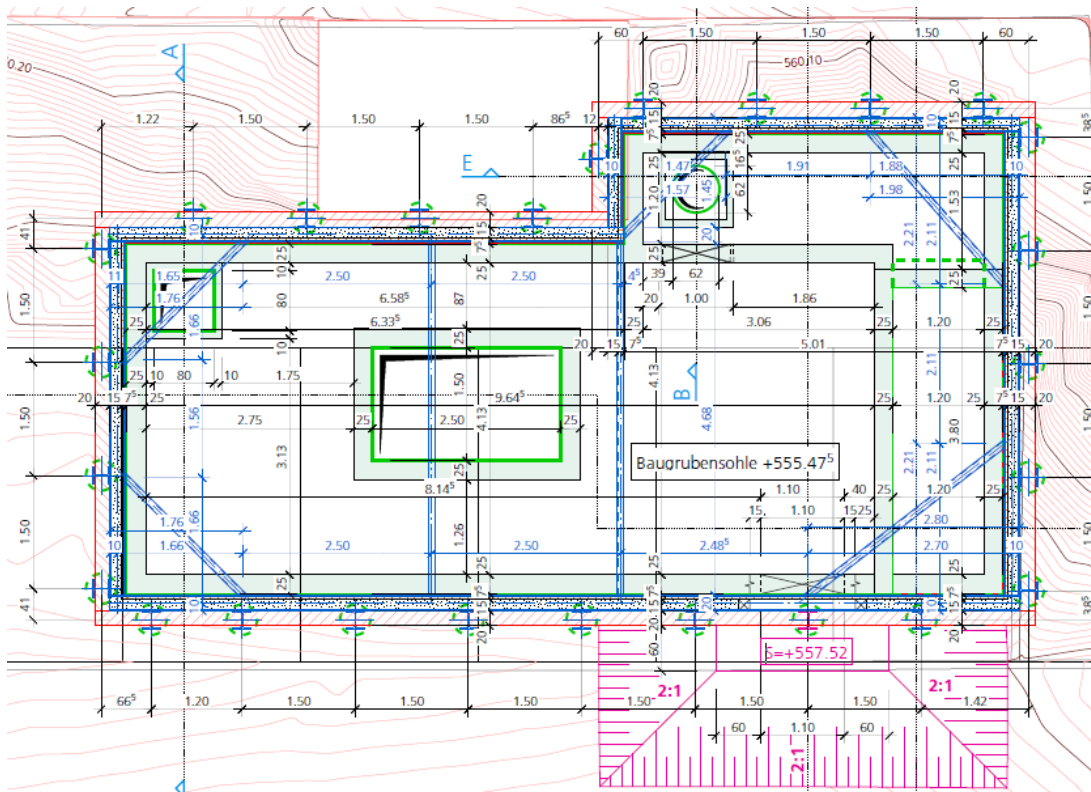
Grundriss Baugrube Somazzistrasse
